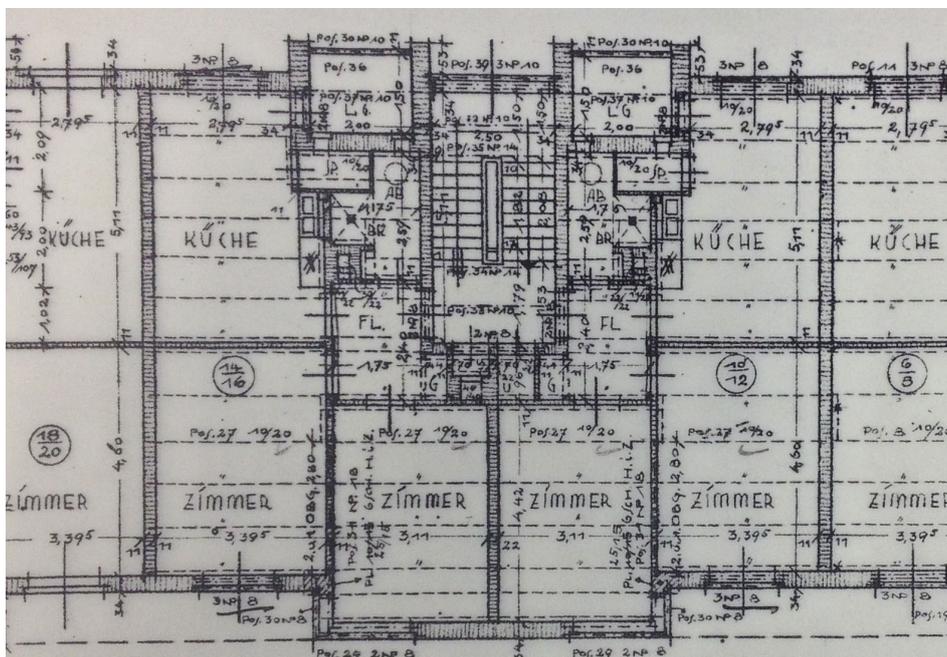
Grundriss Abschnitt A, 1.-3. Obergeschoss, Ausschnitt, Mai 1927
